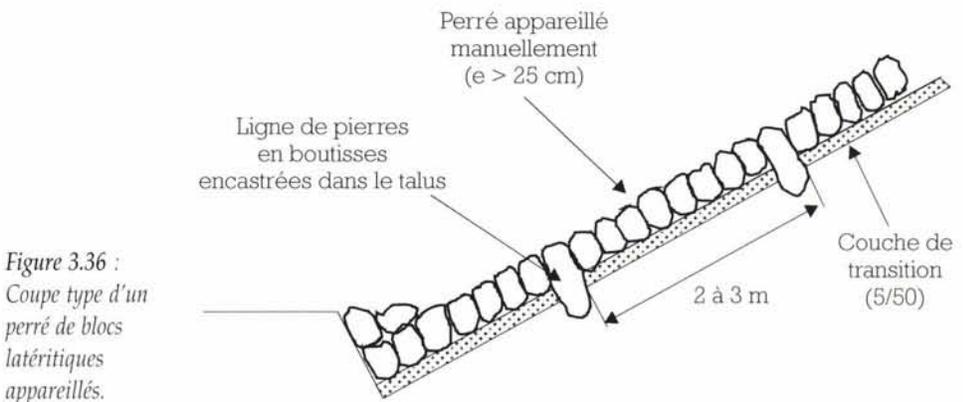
Coupe type d'un perré de blocs latéritiques appareillés.
